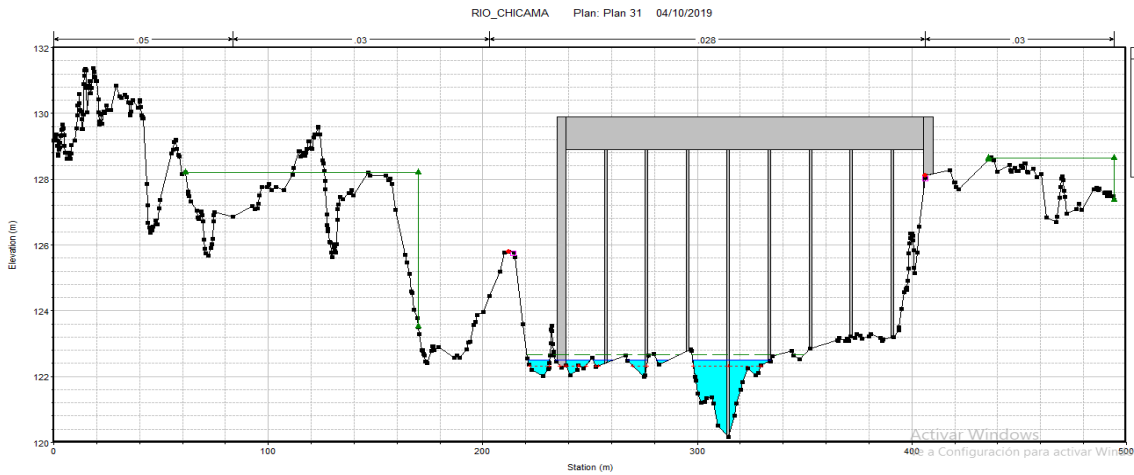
Sección puente viejo en PF1 con un tirante de 2.09m.
